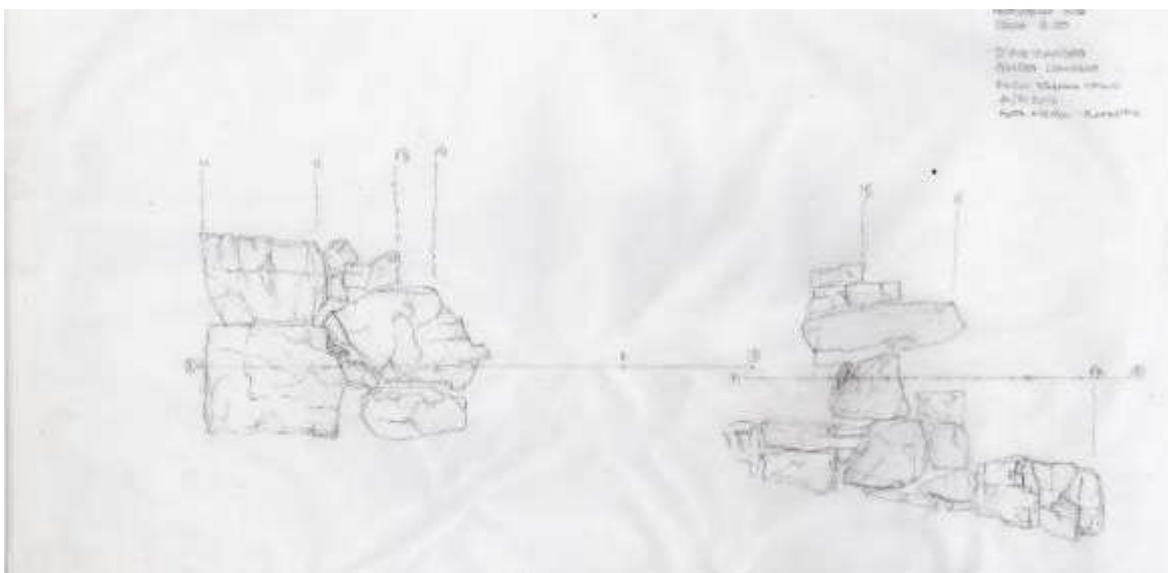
Porta dell'Acropoli, prospetto Sud.
